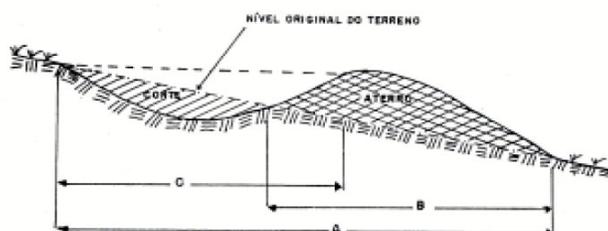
Visão esquemática de perfil do terraço indicando: a secção de corte(C), a secção de aterro (B) e secção do terraço (A) (Fonte: BERTOLINI et al., 1989).
